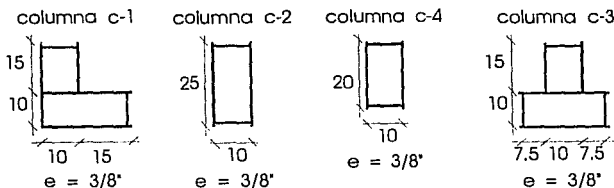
TIPOS DE COLUMNAS UTILIZADAS EN LA ESTRUCTURA METÁLICA
